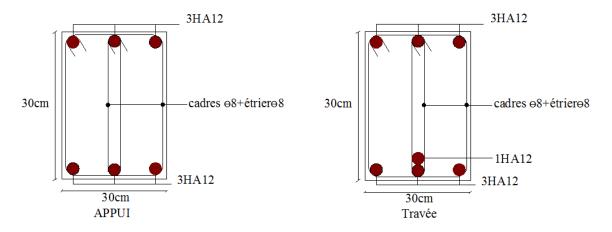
Schéma de ferraillage de la poutre de chainage.
